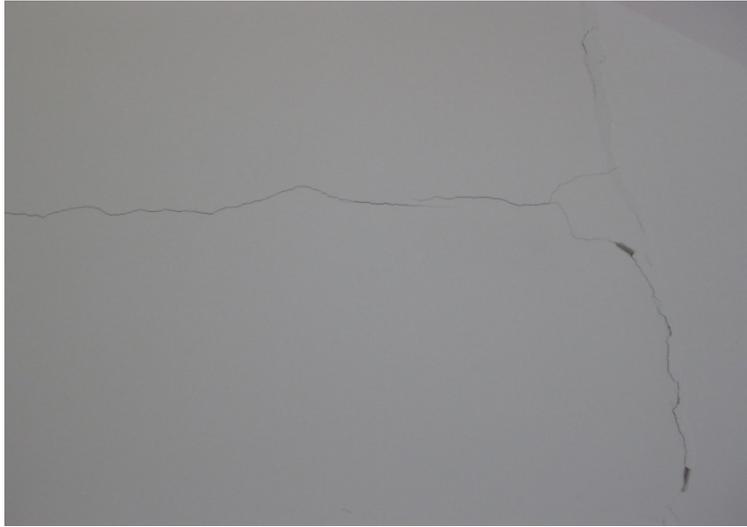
Contact Center* de Seia - Fissuração do reboco na zona interior de uma parede
